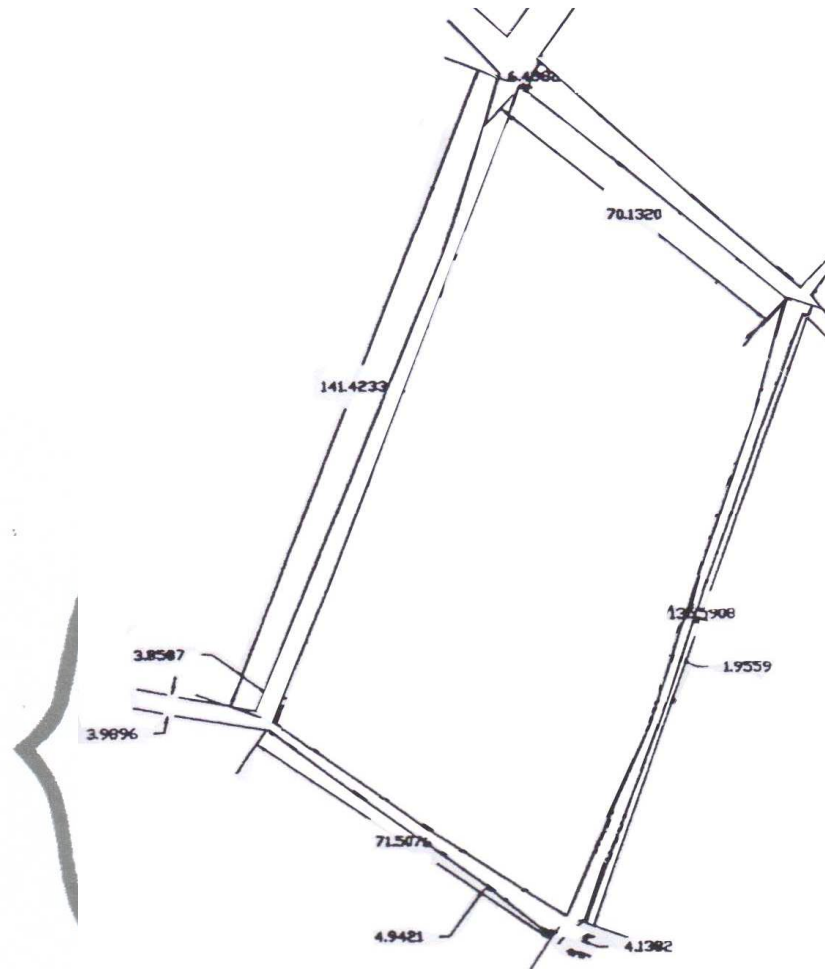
Peta Lokasi Site Plan Kampung Umi Maktum
